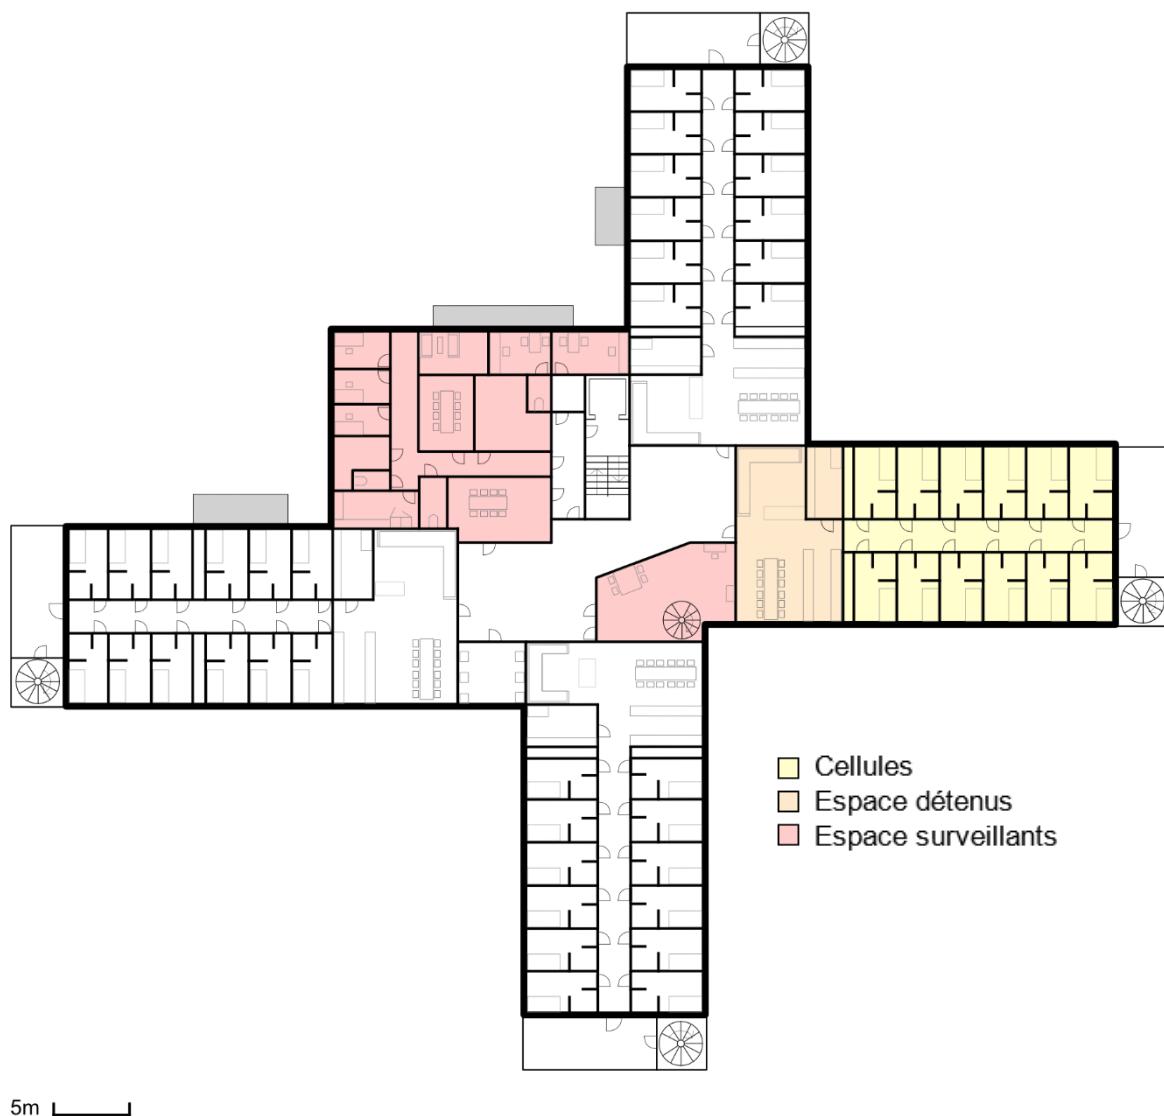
Plan du 1^{er} étage du bâtiment 4a
